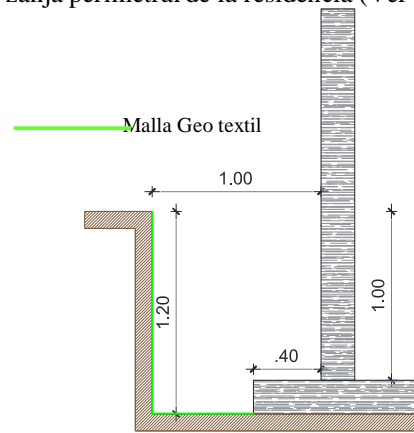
Detalle de Colocación Geo Textil en Cadena (S/E)
